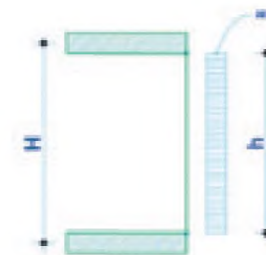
Расчетная схема стойки каркаса стены при воздействии ветровой нагрузки
